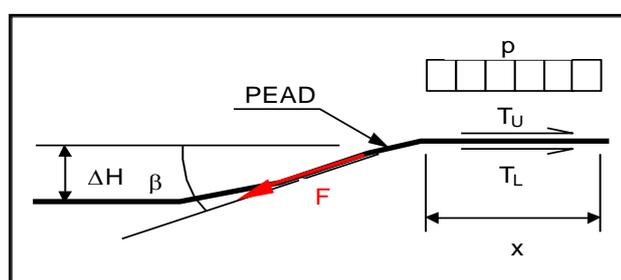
Modelo para cálculo da espessura da manta de PEAD.
